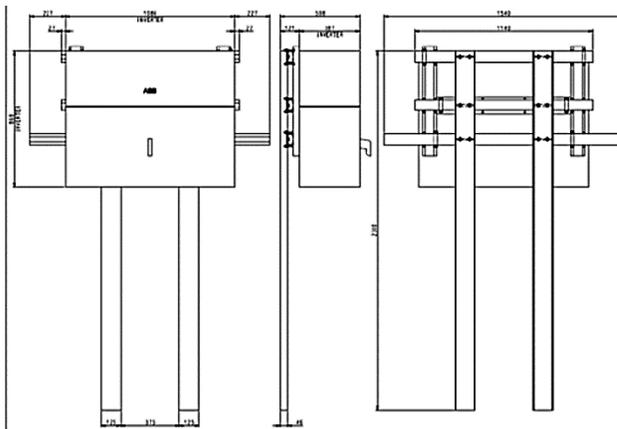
Estructuras metálicas de soporte de paneles y Módulo Fotovoltaico
